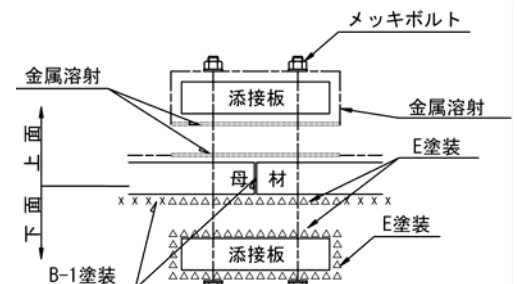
ボルト継手部の防錆仕様(現場施工を除く)
